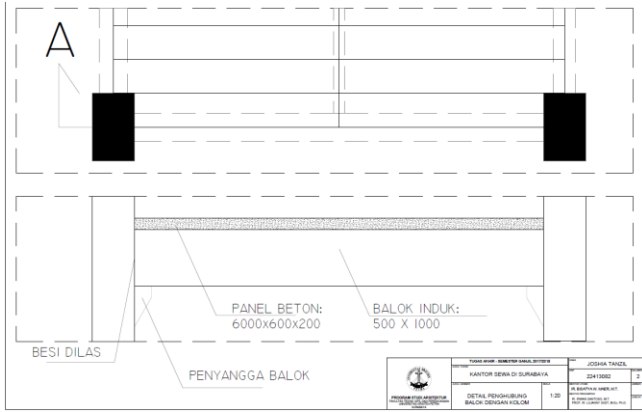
Salah satu contoh penggunaan beton pracetak
